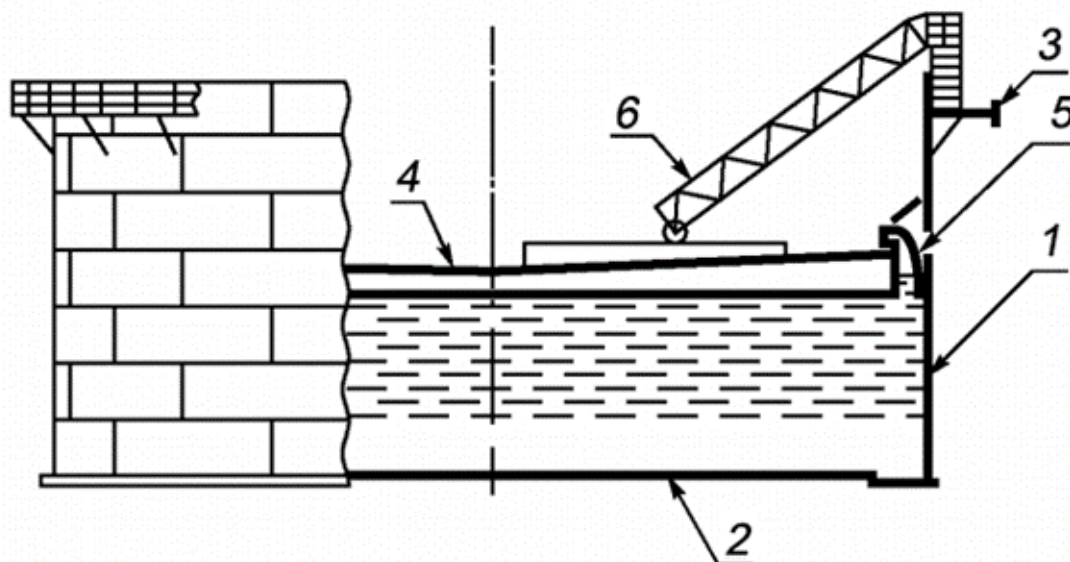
Основные конструктивные элементы РВСПК: 1 — стенка; 2 — днище; 3 — ветровое кольцо; 4 — плавающая крыша; 5 — уплотняющий затвор с погодозащитным козырьком; 6 — катучая лестница
